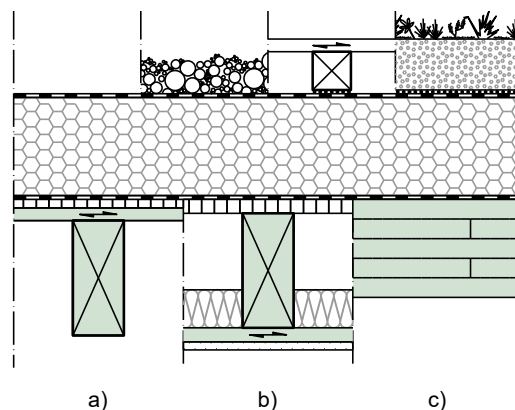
Typ I – Flachdachkonstruktionen mit Aufdachdämmung GK 0
